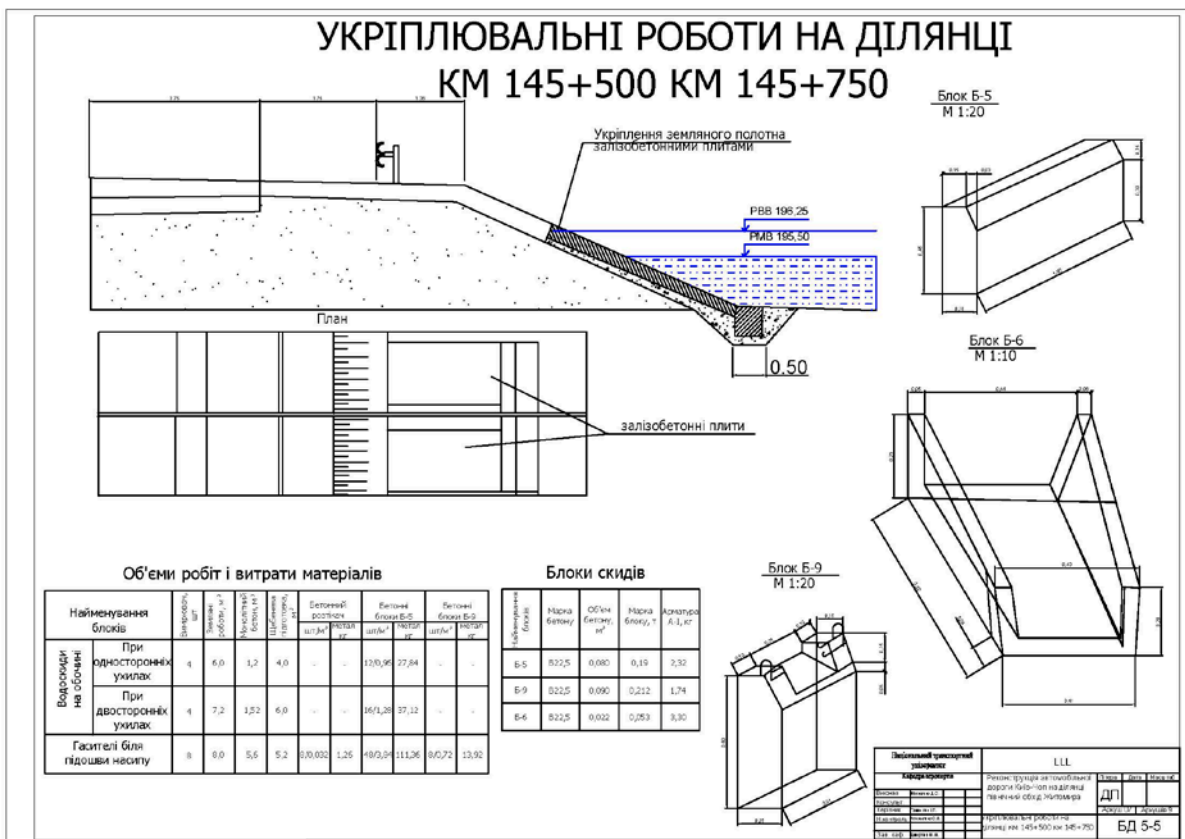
Приклад укріплення земляного полотна залізобетонними плитами
